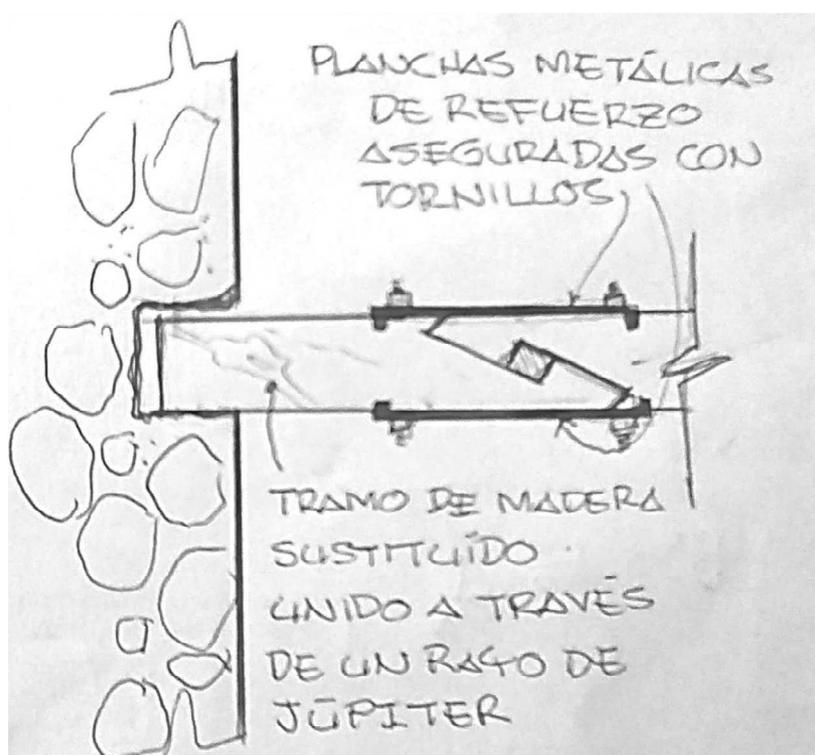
Detalle estructural de sustitución de extremo dañado en viga madera en entrepiso. Fuente: Croquis realizado por el autor. Agosto 2017
